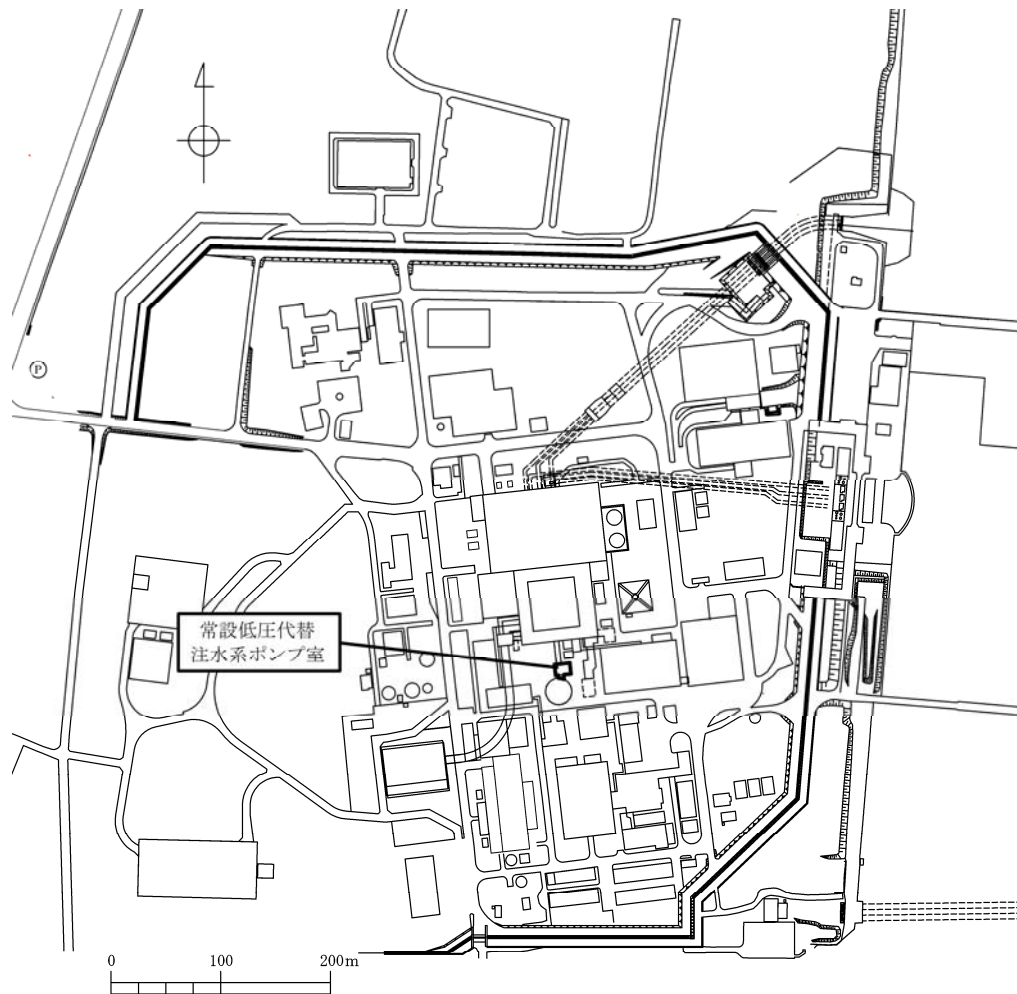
(1) 常設低圧代替注水系ポンプ室 平面配置図 (全体平面図)
